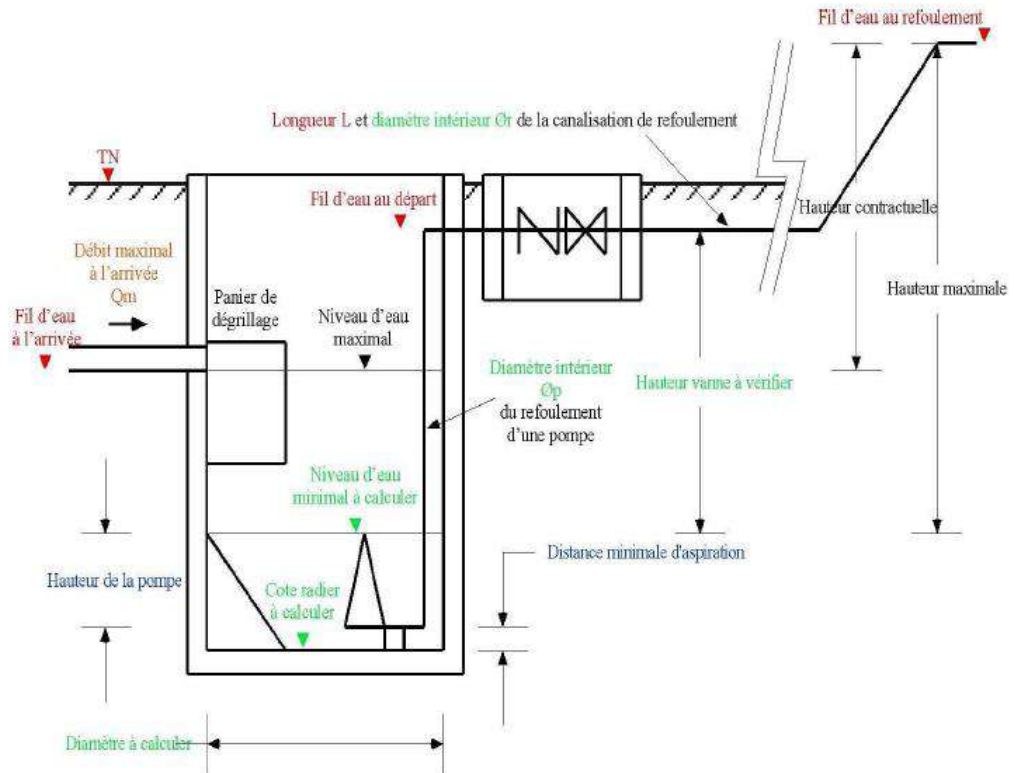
Exemple d'une station de relevage.(Benazzouz, 2007)
